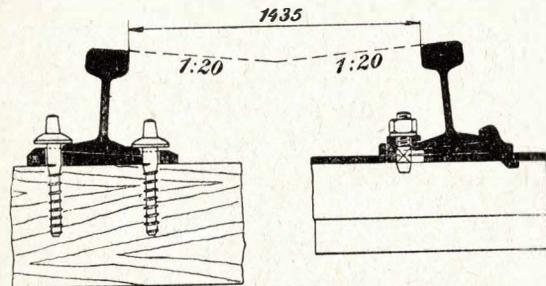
Schienenbefestigung für Holz- und Eisenschwelle.
